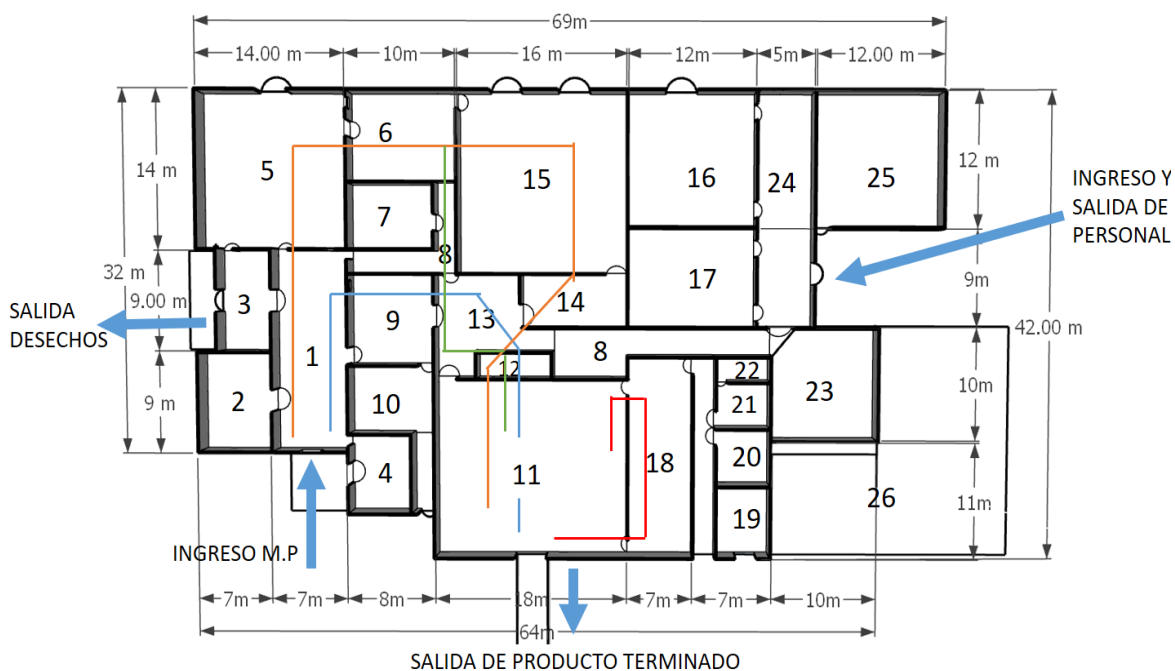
Diseño del plano conceptual de la planta procesadora de camarón.
